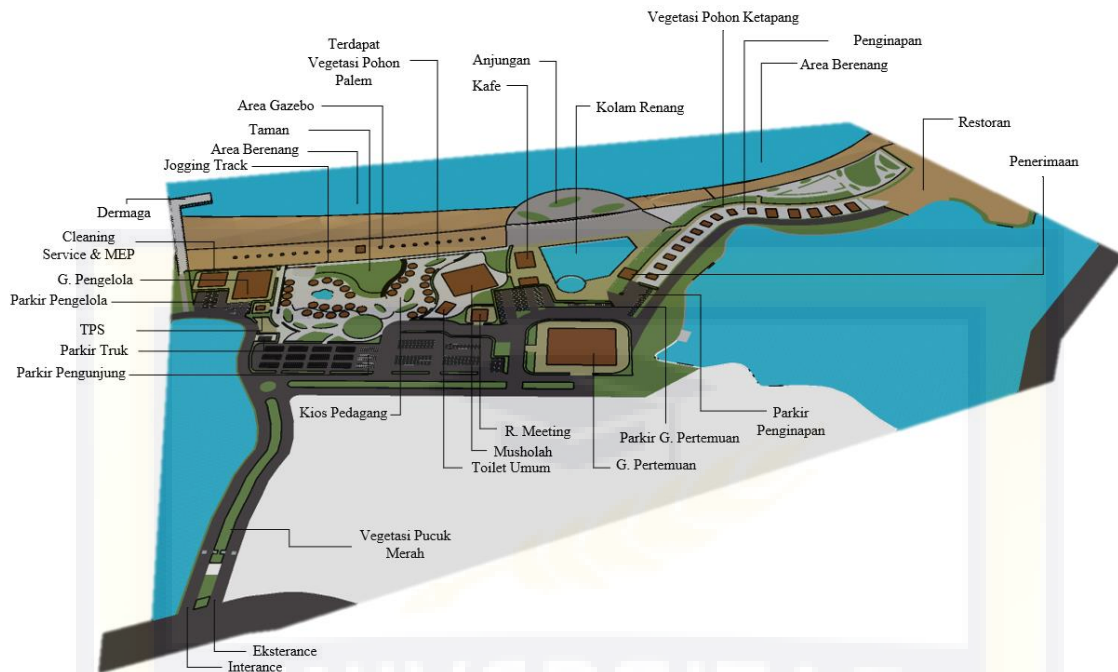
Perancangan Site Plan Pantai Indah Bosowa
